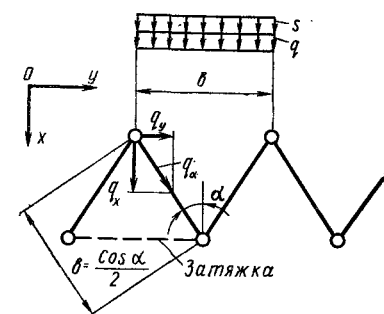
Схема приложения нагрузки к поперечному сечению складки
